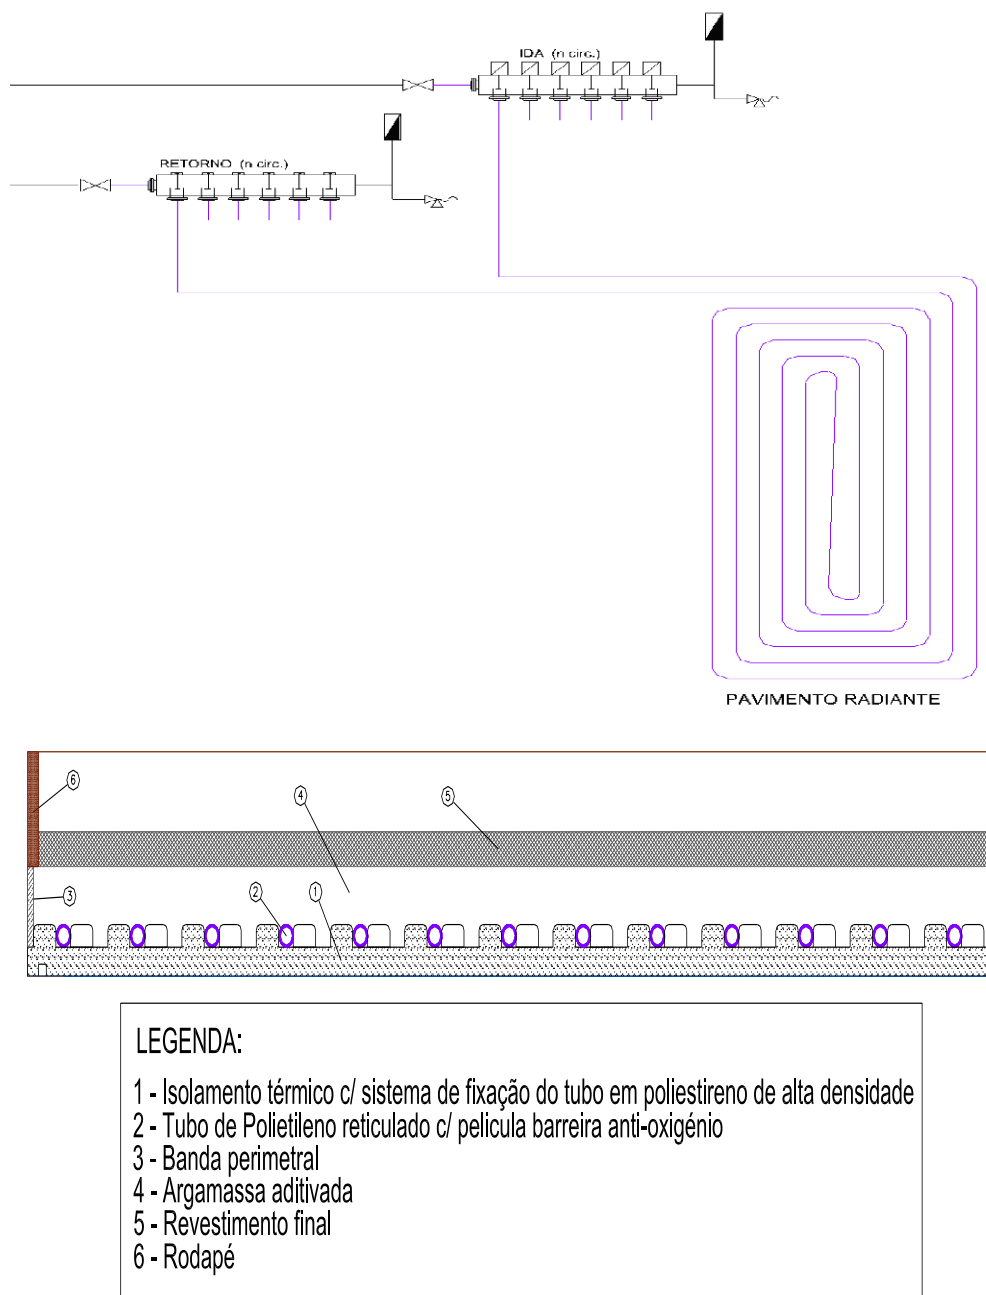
Pormenor da espiral no pavimento, de ligação e constituição do piso radiante.
